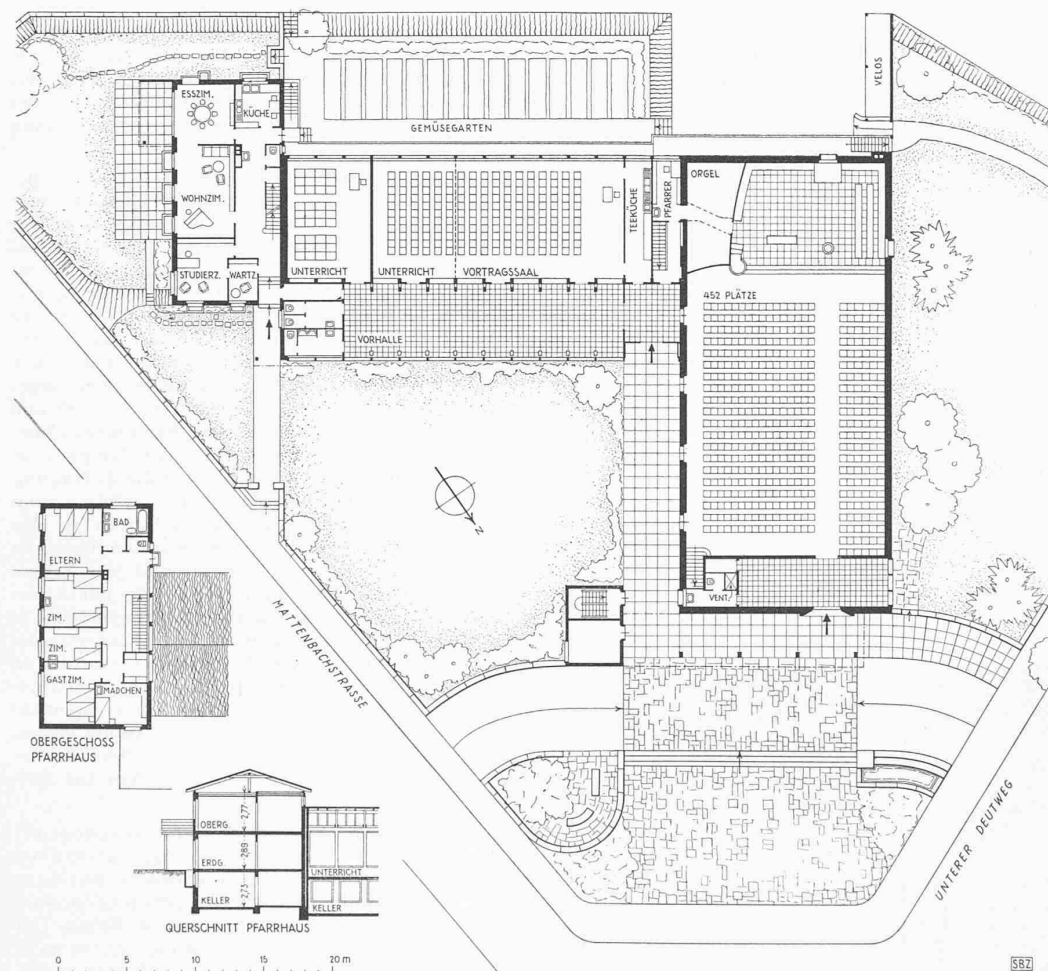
Grundrisse und Schnitt 1:500
